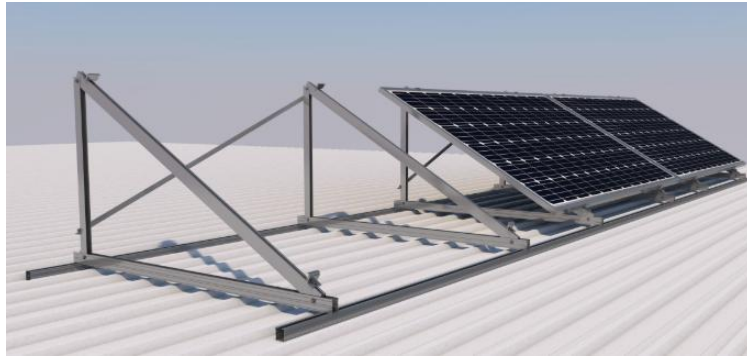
Estrutura de fixação dos painéis fotovoltaicos para telhado plano de chapa metálica [52]
